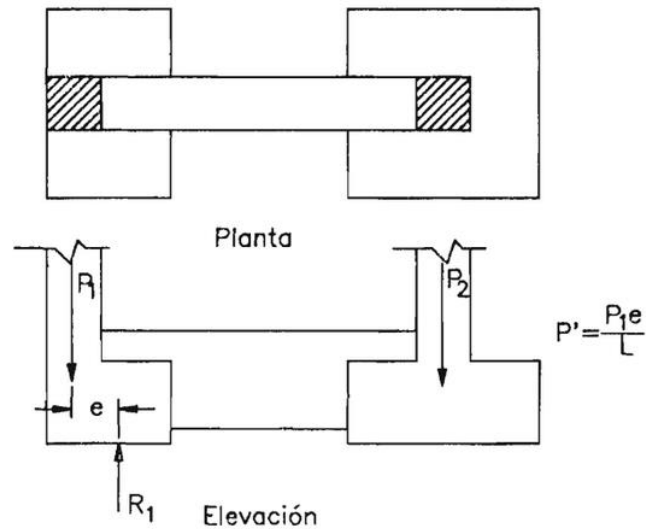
Acciones de la carga excéntrica y viga de cimentación conectada a zapata central.
